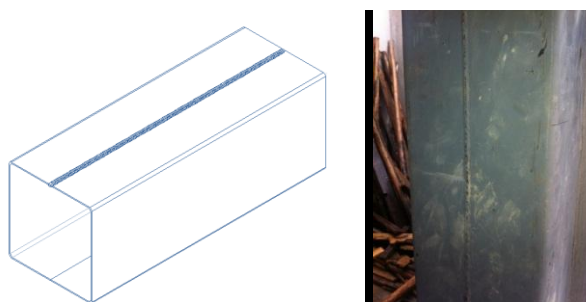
Soldadura CJP a tope (columna-viga) Sector Norte-La Carolina
